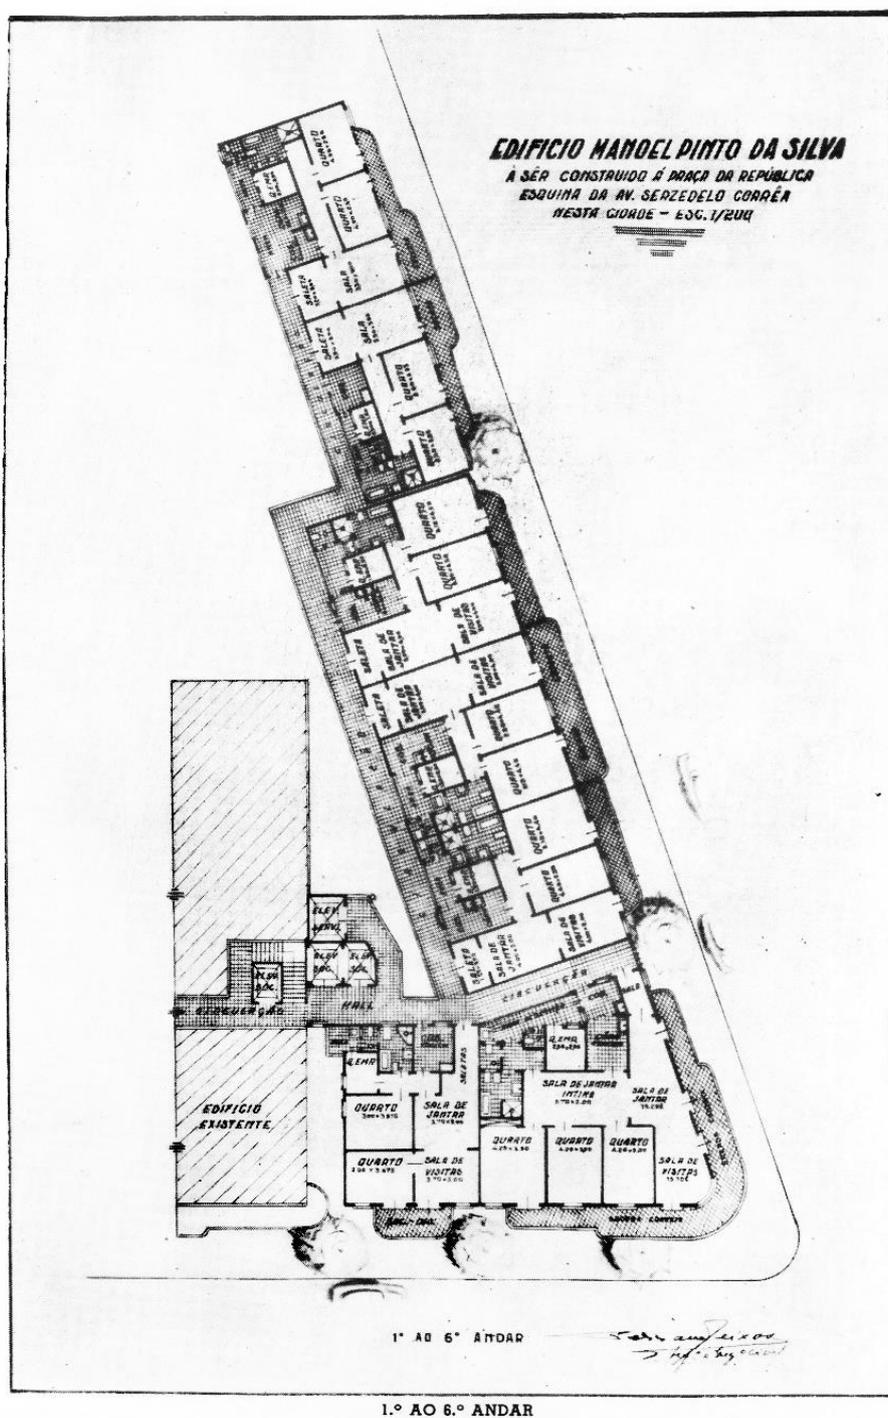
Planta Baixa original do projeto (1º ao 6º pavimento).
